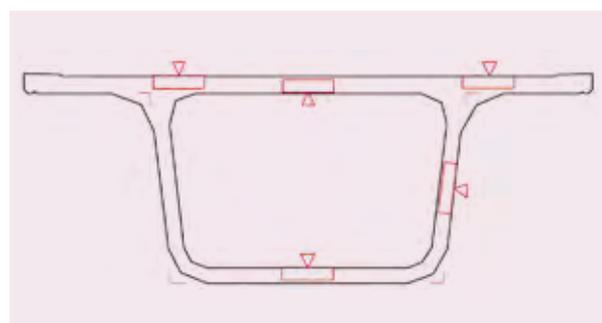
position des prélèvements dans le voussoir d'essai. Les flèches indiquent les faces testées lors de l'essai de flexion
